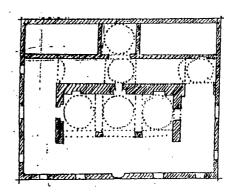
مسقط أفقى لمسجد طلختان باب قرب مرو (عن : Kuban) .
